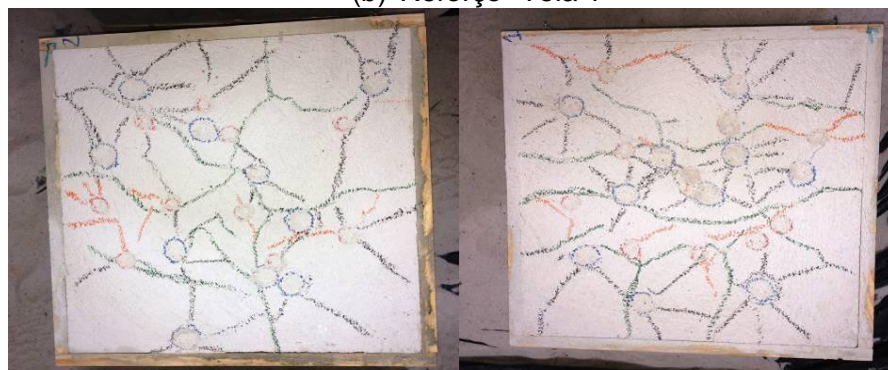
Detalhe das fissuras nos prismas devido ao ensaio de impacto.
